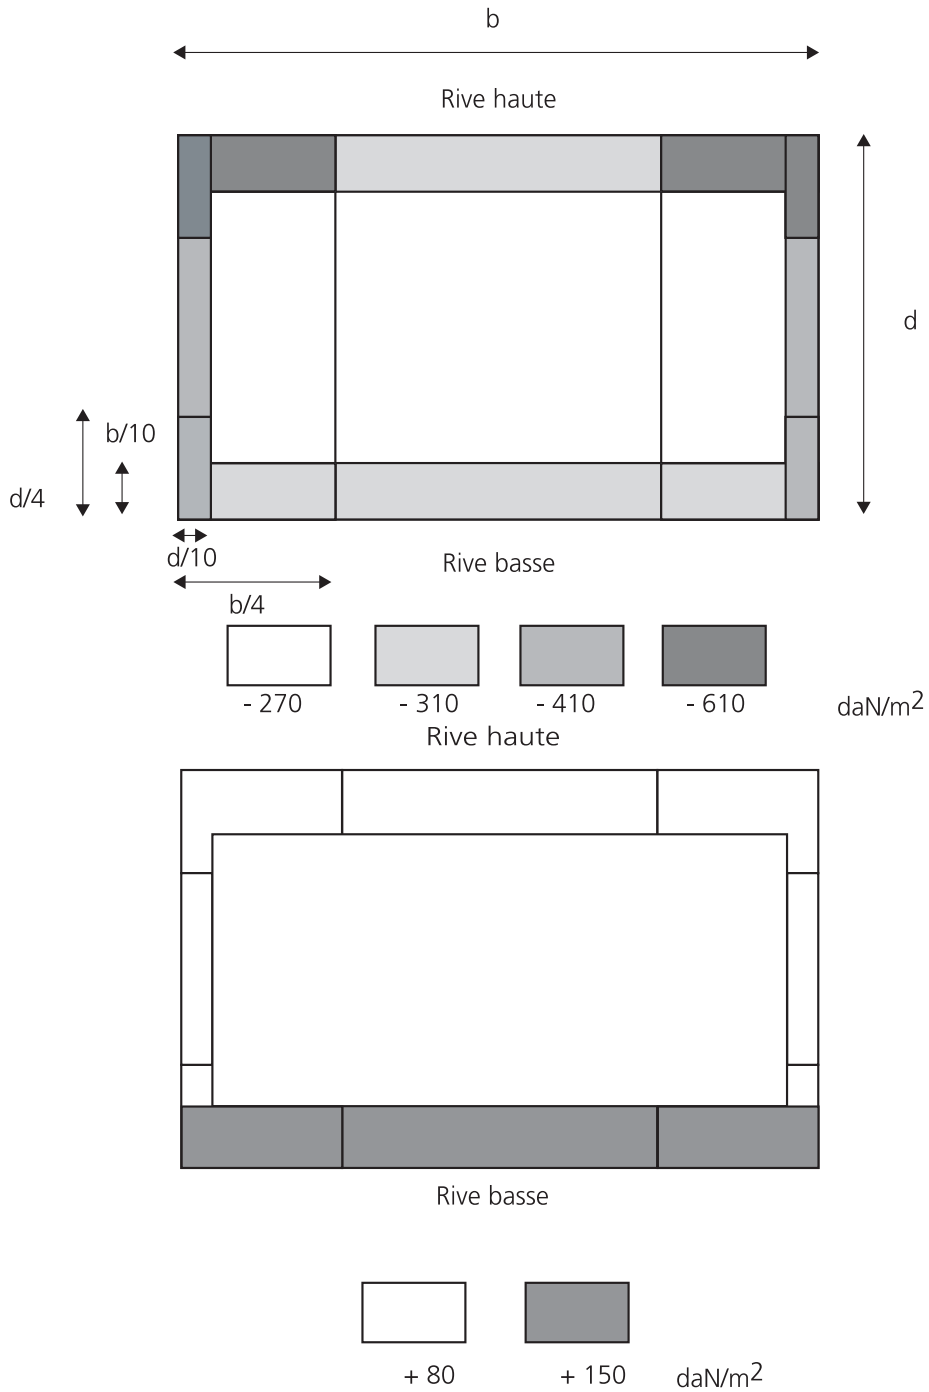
Charges forfaitaires d'arrachement et d'écrasement sur une toiture à un versant de pente = 30° - $h \leq 10$ m
